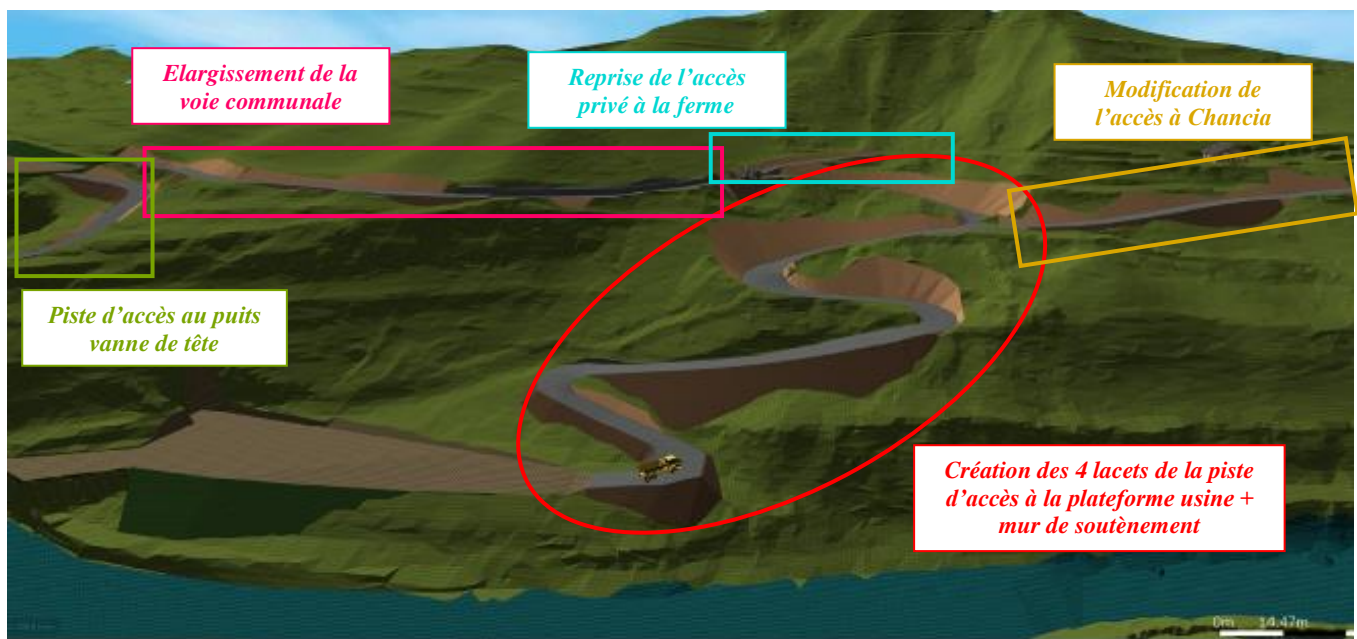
Vue 3D des pistes d'accès et de la plateforme usine
